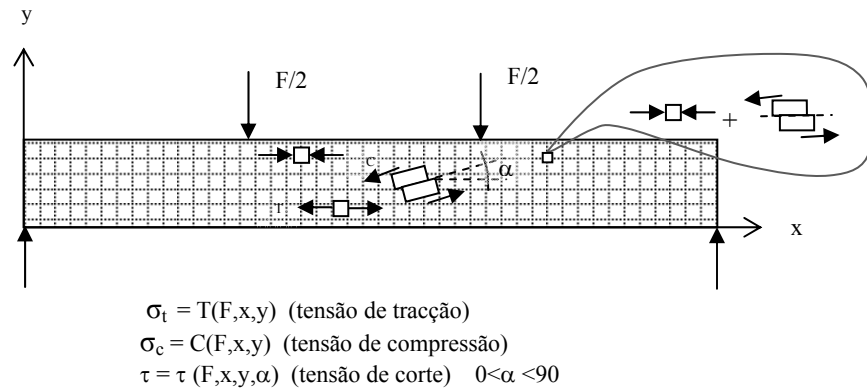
Indução de tensões de tracção, compressão e corte em direcções e conforme a localização no elemento submetido à flexão.
